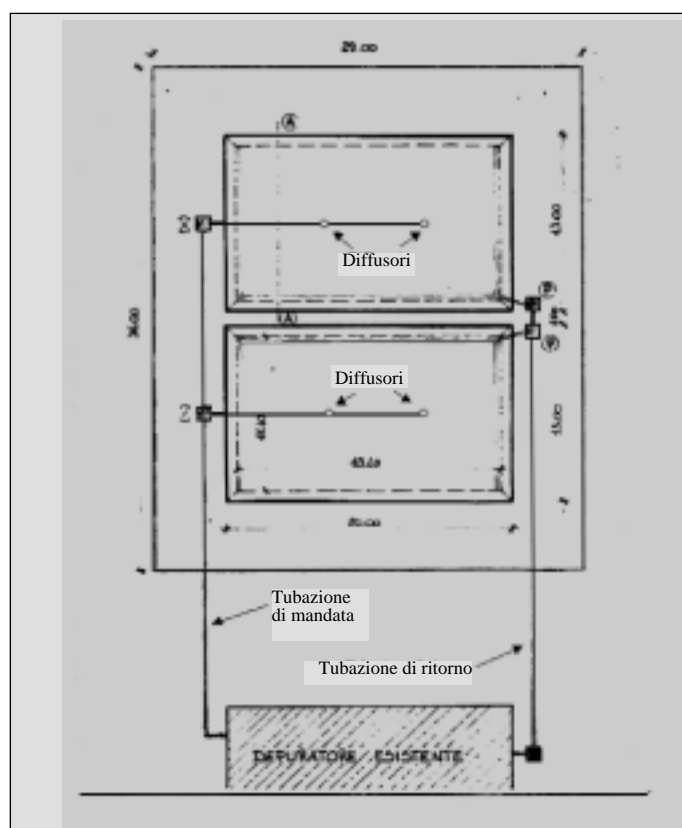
Stratigrafia del letto drenanteFig. 2 - Pianta dell'impianto
